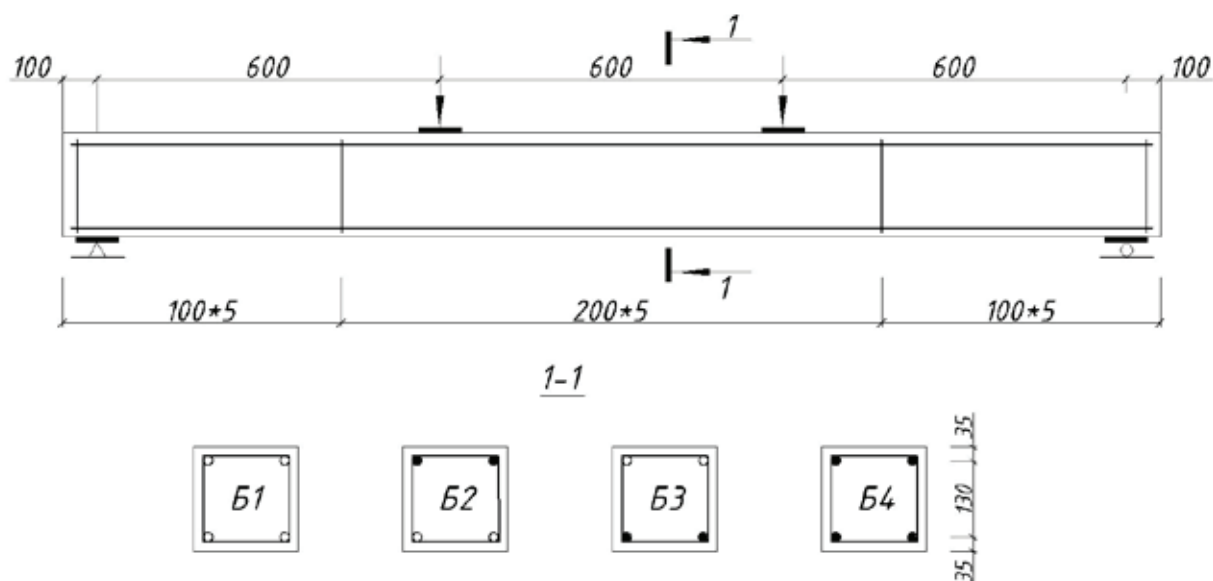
Конструкция опытных образцов железобетонных балок со стыковыми соединениями продольных арматурных стержней
